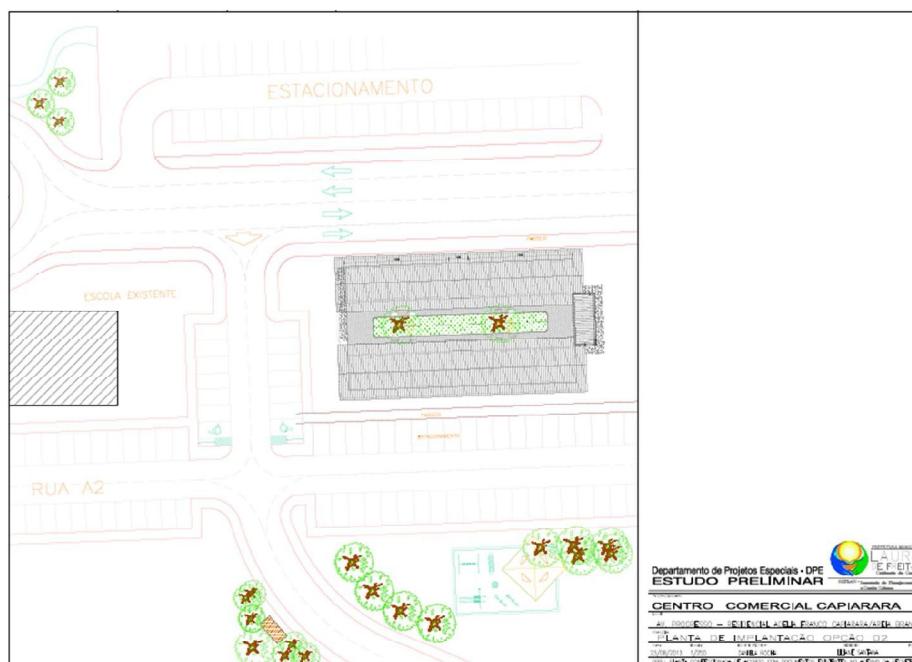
Planta de implantação do Centro Comercial Capiarara – opção 2.
